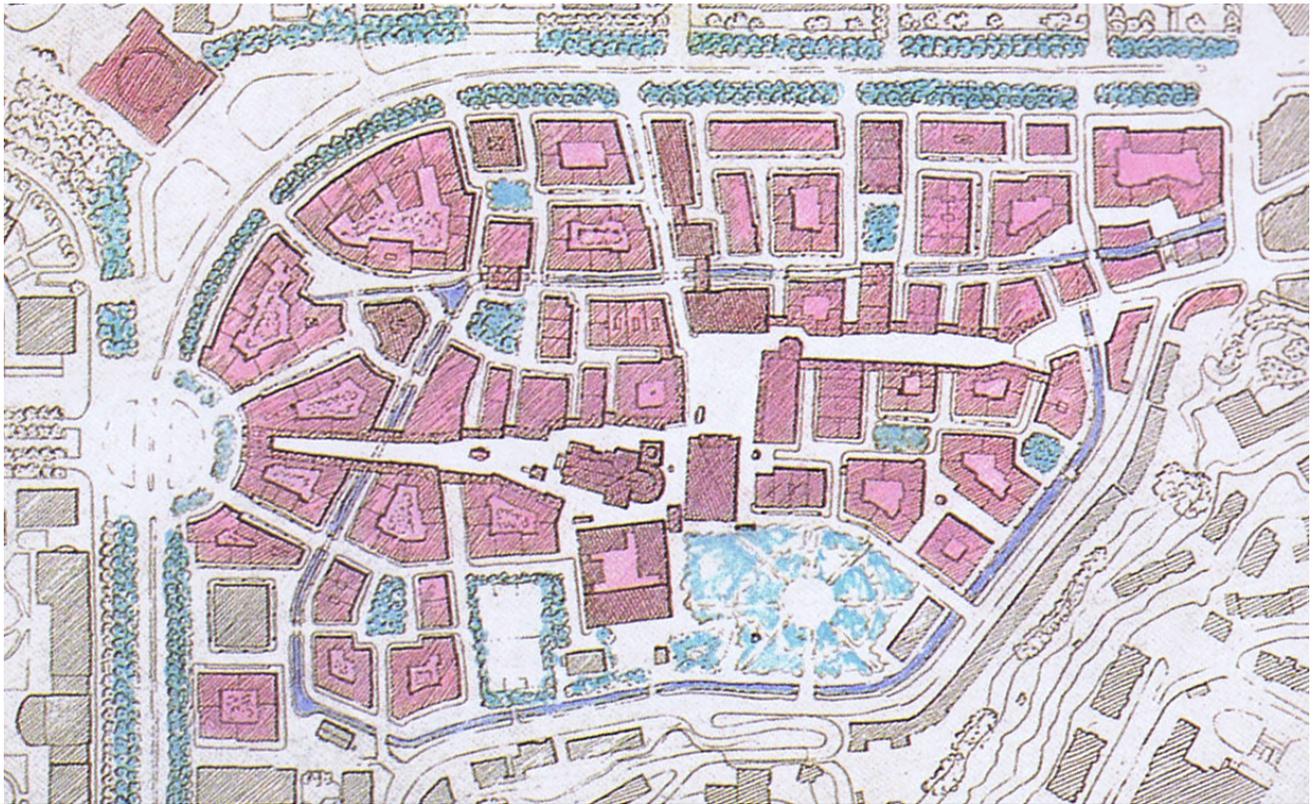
Plano de la primera propuesta de los hermanos Krier retocado por el autor - R.C.A. Pág. 64
